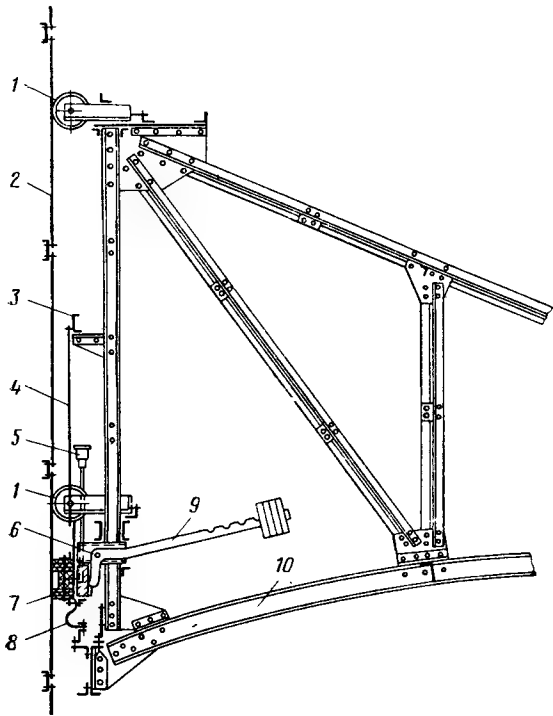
Общий вид затвора сухого газгольдера с консистентной смазкой
